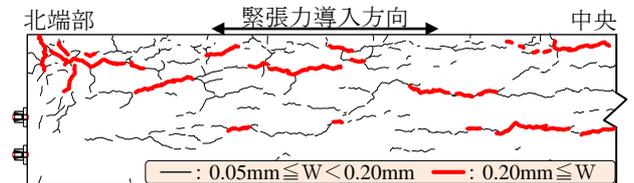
(1)に材齢 1300 日のひび割れ図を示す。ひび割れは、緊張力導入方向に卓越しており、ASR 劣化した PC 部材に生じるひび割れの特徴が現れている。また、図-2(2)からひび割れ密度(対象ひび割れ総延長/評価対象面積)は、材齢 300 日以降急激に増加し、材齢 1300 日までに 10.78m² と大きく劣化が進展し、全体の 30%程度が幅 0.20mm 以上のひび割れとなった。
